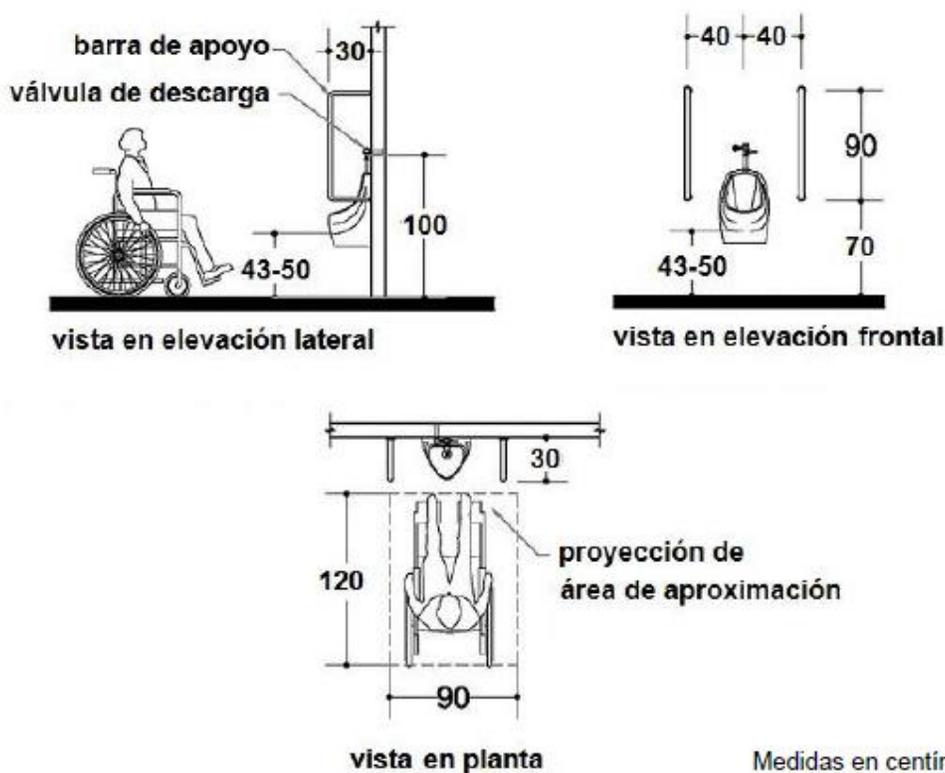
Vista en elevación lateral, frontal y en planta del urinario con sus respectivas barras de apoyo. Recuperado de (CONAIPD, 2014)
